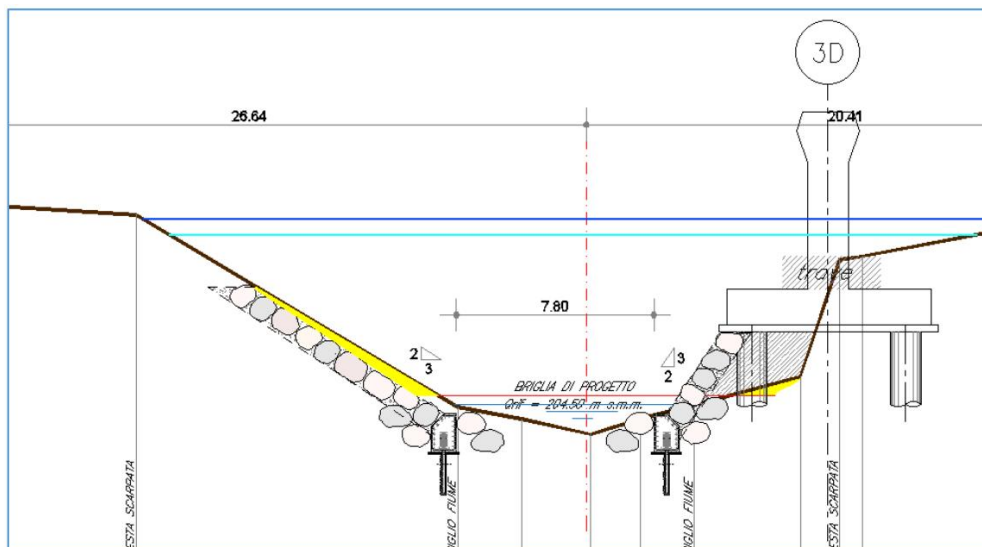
Sezione trasversale primo progetto (rel. 2018)
